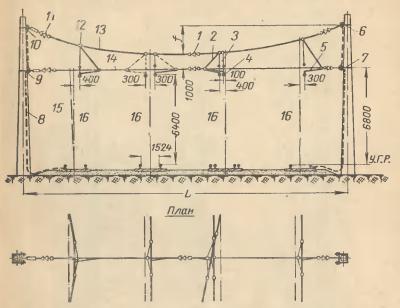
Поперечная подвеска контактных проводов на гибких поперечинах.
